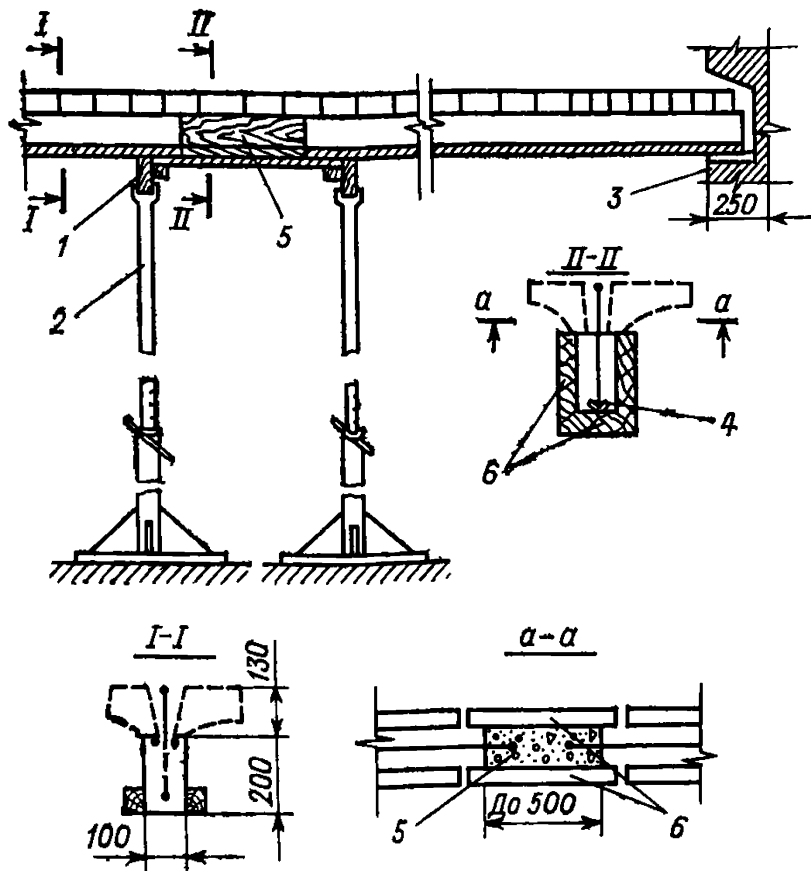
Устройство стыка двух полубалок конструкции Лаптера
